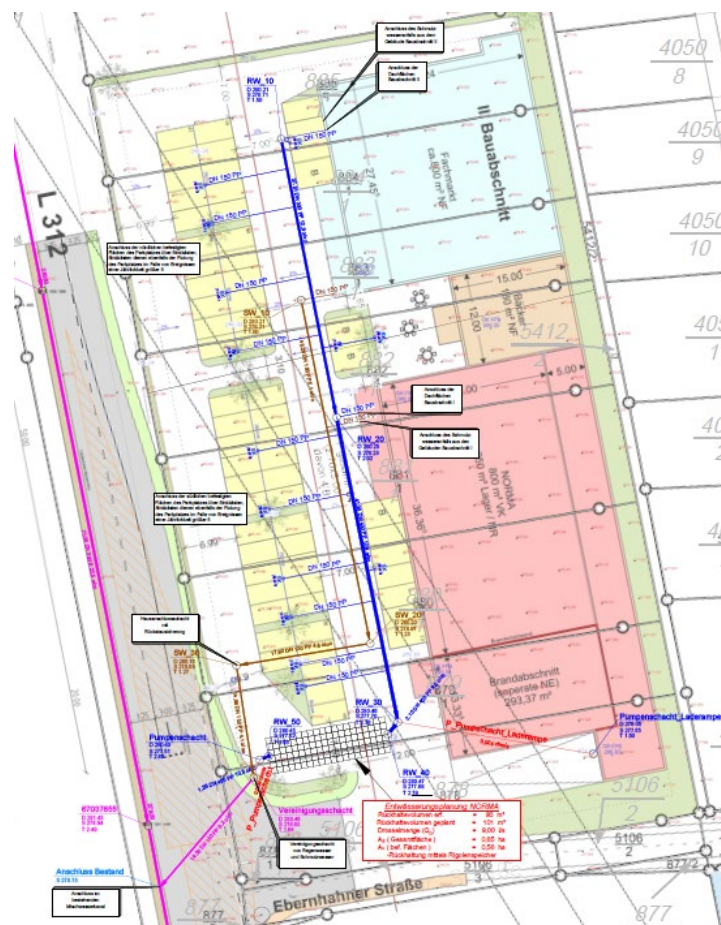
Lageplan Entwässerung [Quelle: Auszug Anlage 3]
